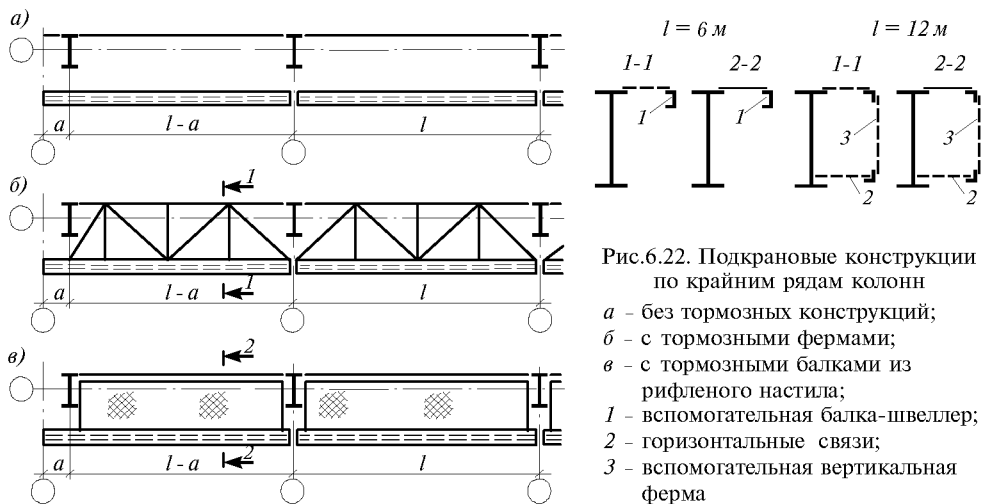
Подкрановые конструкции по крайним рядам колонн
